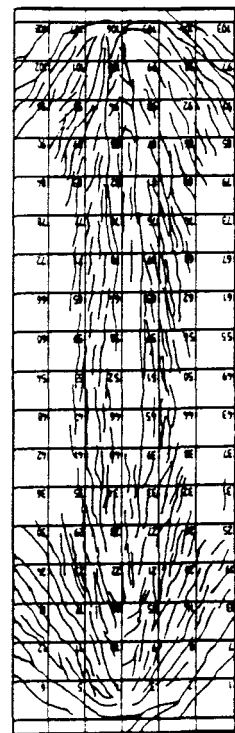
Beobachtete Rißbilder und ausgefallene Betonelemente an der Plattenoberseite des Versuchskörpers S3
